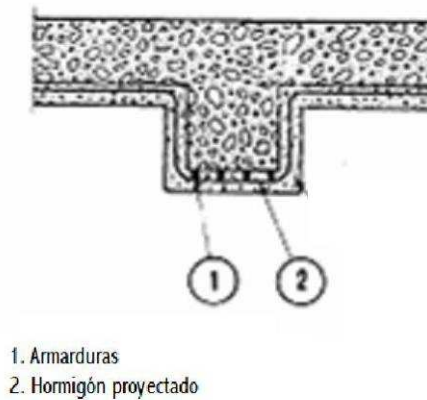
Consolidación de vigas mediante hormigón proyectado
